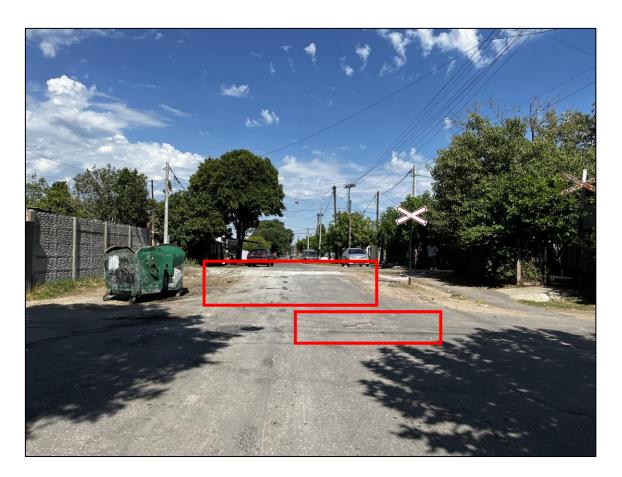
Estado de la calzada: aristas indefinidas y presencia de baches. Fuente: JST, enero 2023
